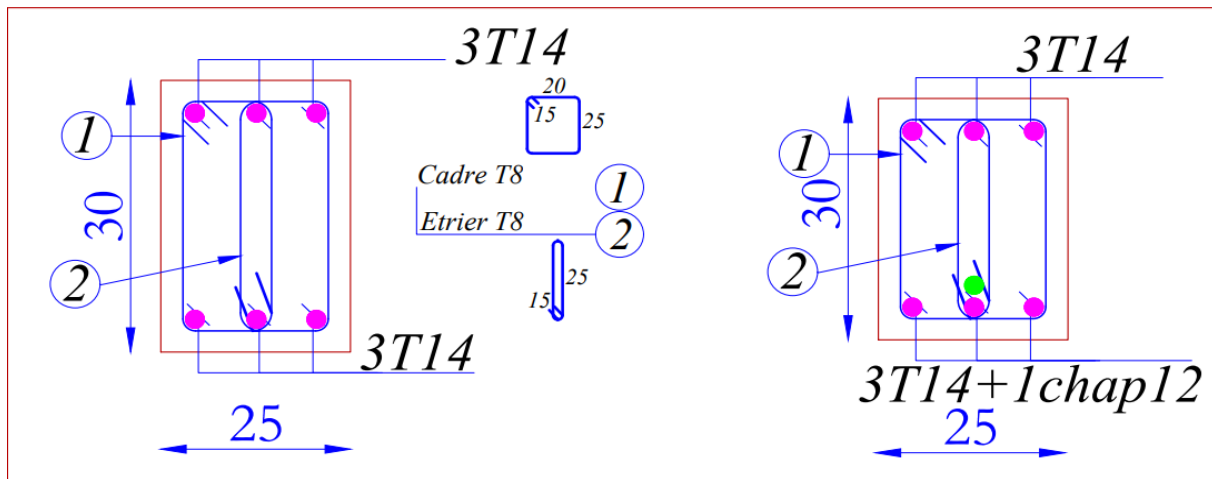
schéma de ferraillage des poutres Chiénage.
